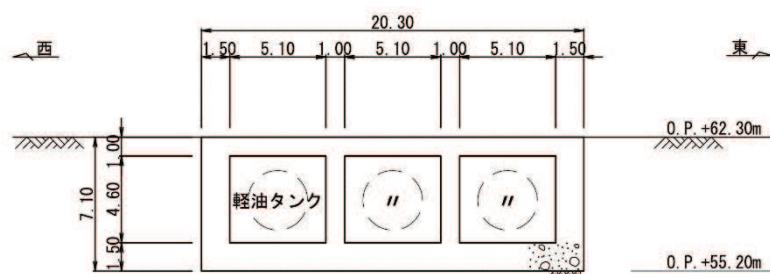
ガスタービン発電設備軽油タンク室断面図 (B-B断面)
